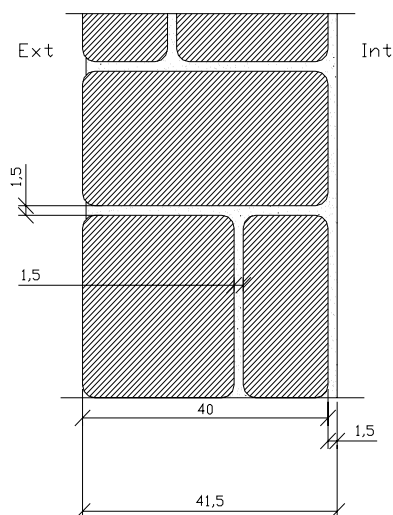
Secção tipo de uma parede simples estrutural de pedra ou adobe
